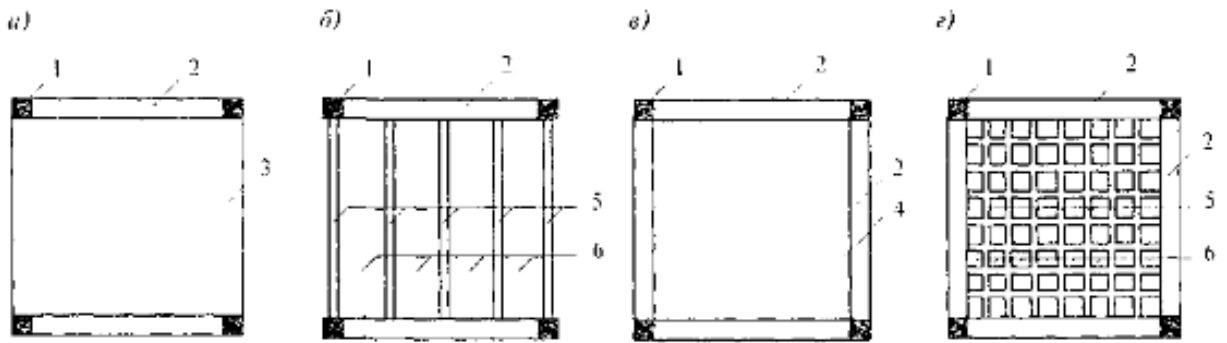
Плиты перекрытий в колонных КС с балками и в стеновых КС
